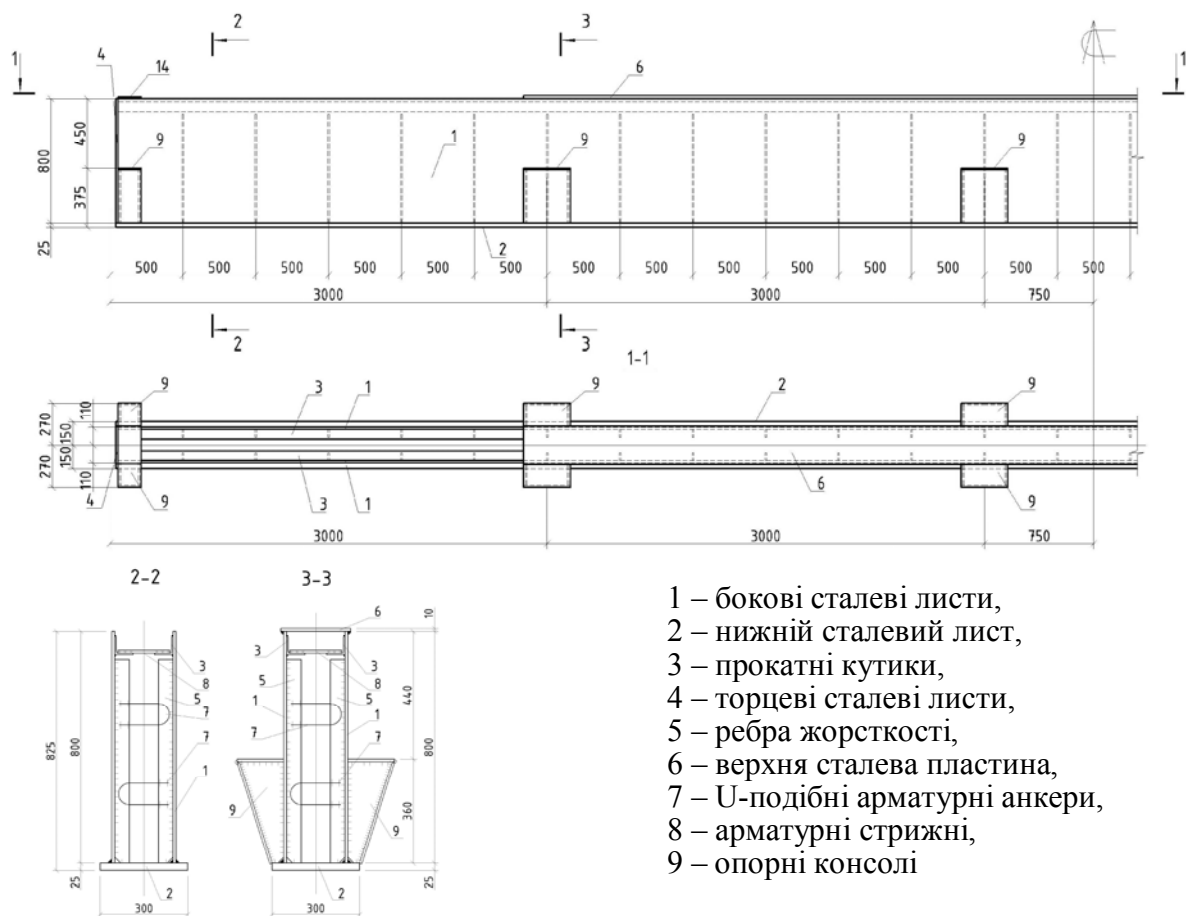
Креслення сталезалізобетонного ригеля покриття Б1
